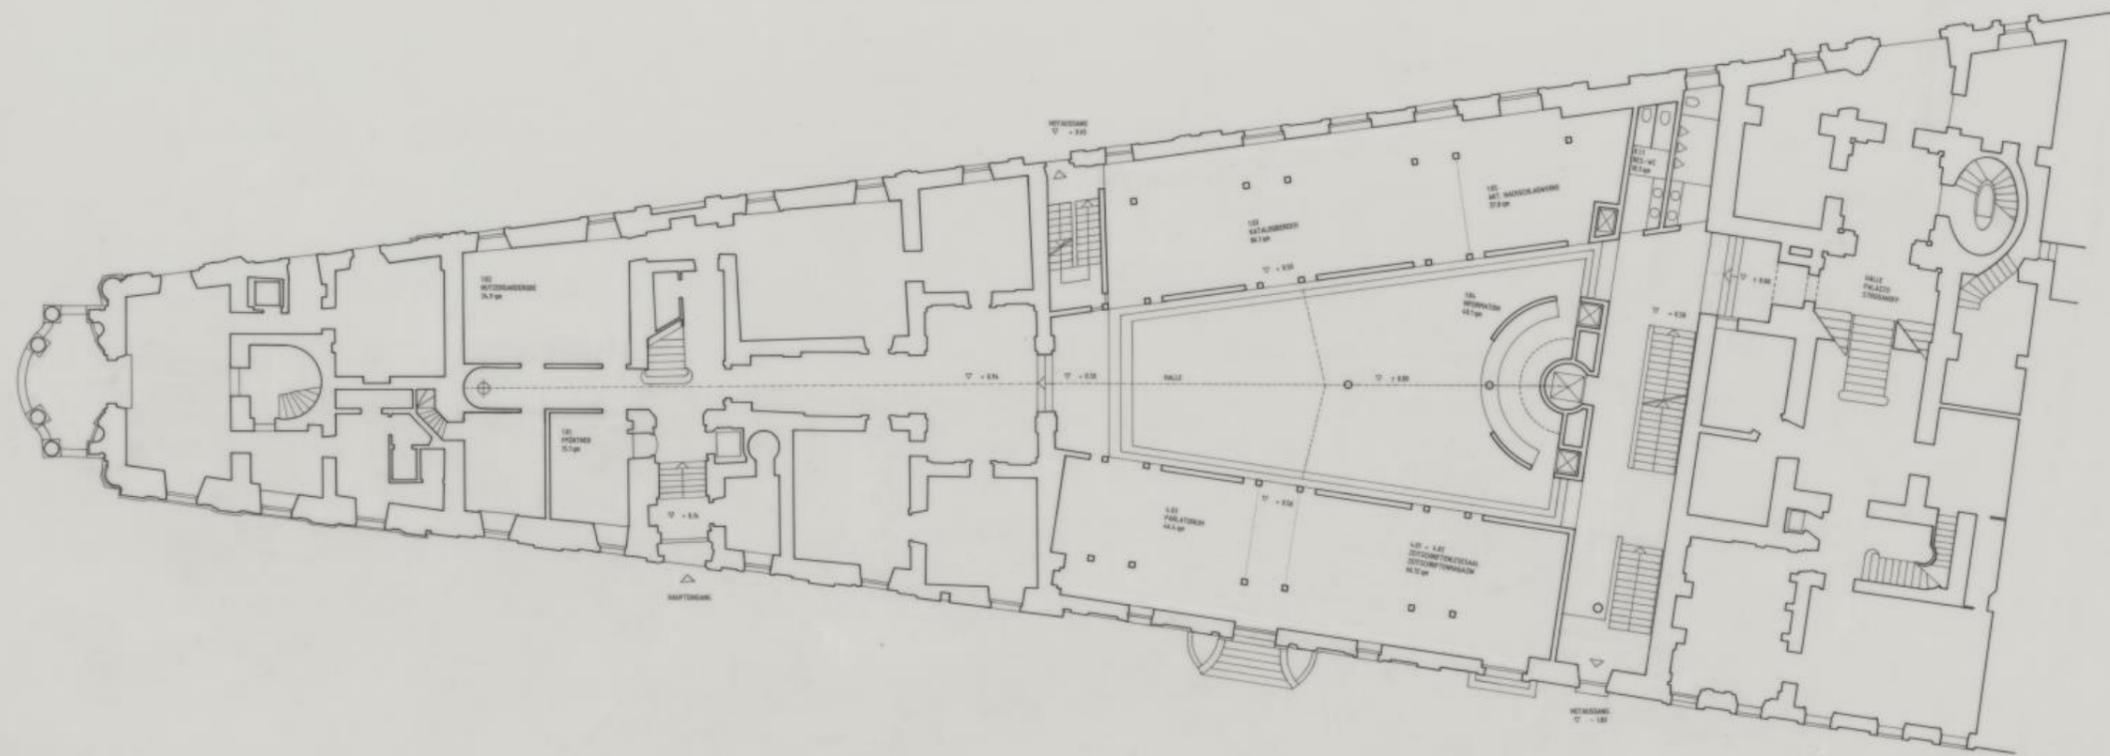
Alexander von Branca Wettbewerbsentwurf (Grundriss Erdgeschoss Ebene 3) M 1:100, 1995
